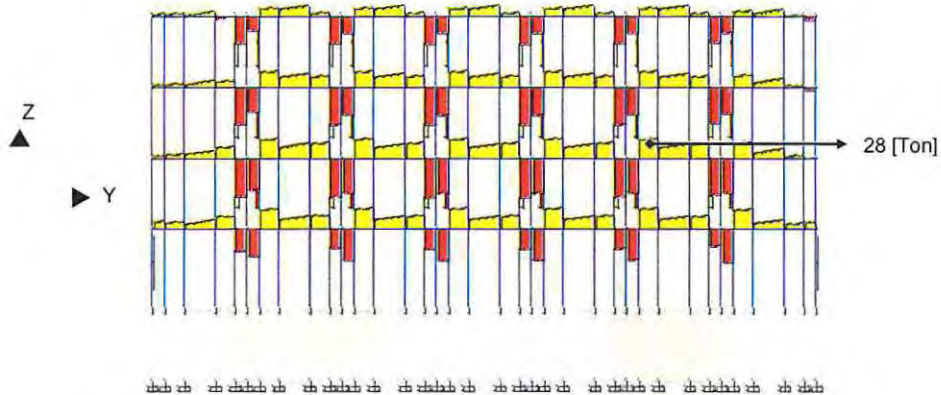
Diagrama de corte en vigas de fachada, eje A, condición actual.
